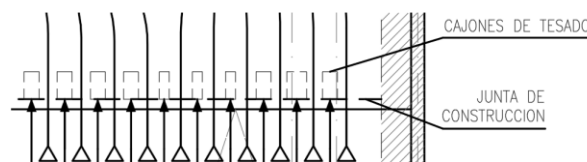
Detalle con anclajes solapados y cajones de tesado.
